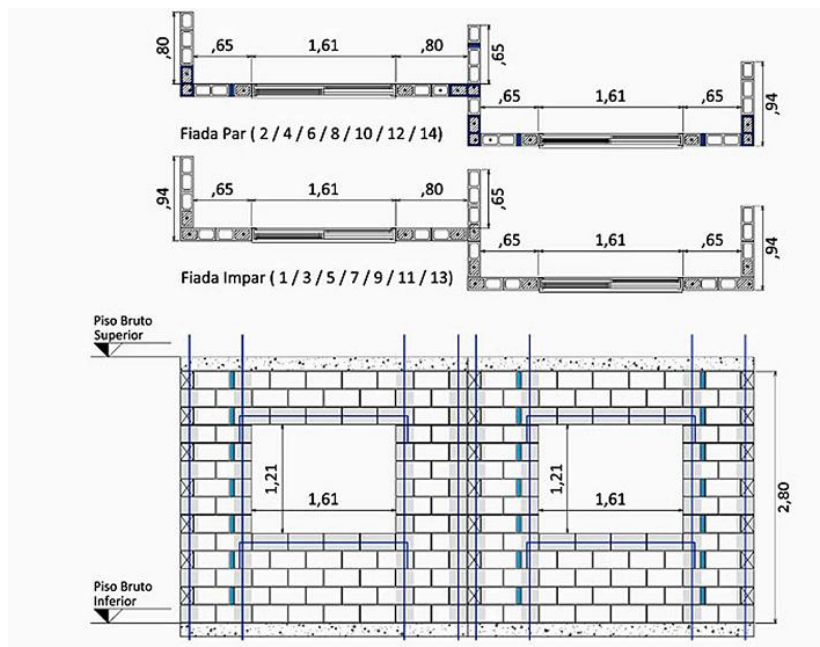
Alvenaria Armada (TAUIL, 2010)
